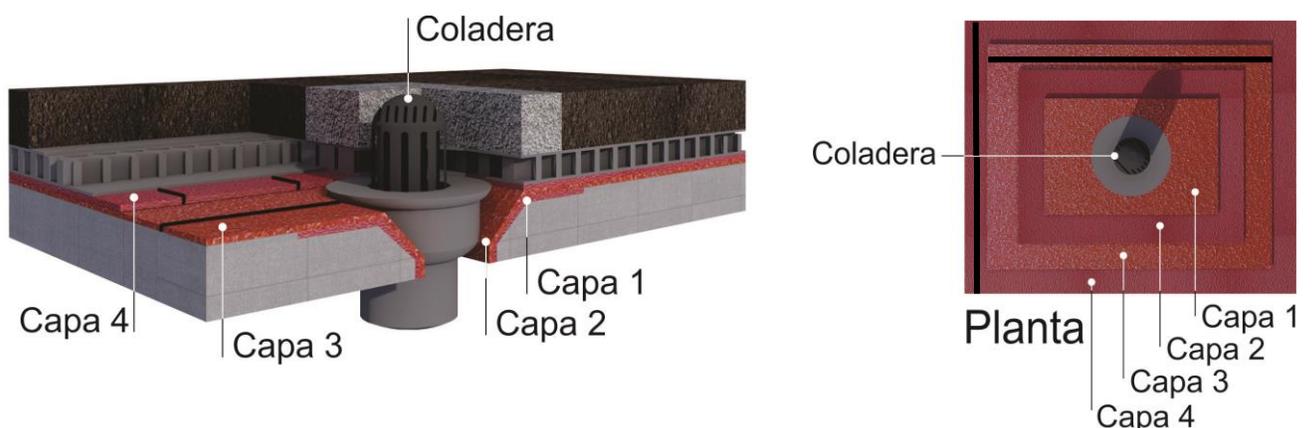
Impermeabilización y refuerzo en puntos de encuentro con bajadas de agua
